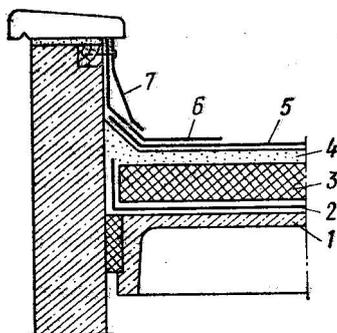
Примыкание кровли к парапету: 1 – плита покрытия; 2 – пароизоляция; 3 – утеплитель; 4 – армированная стяжка с поднятым бортом; 5 – рулонный ковер; 6 – два дополнительных слоя изоля; 7 – фартук из оцинкованной кровельной стали
